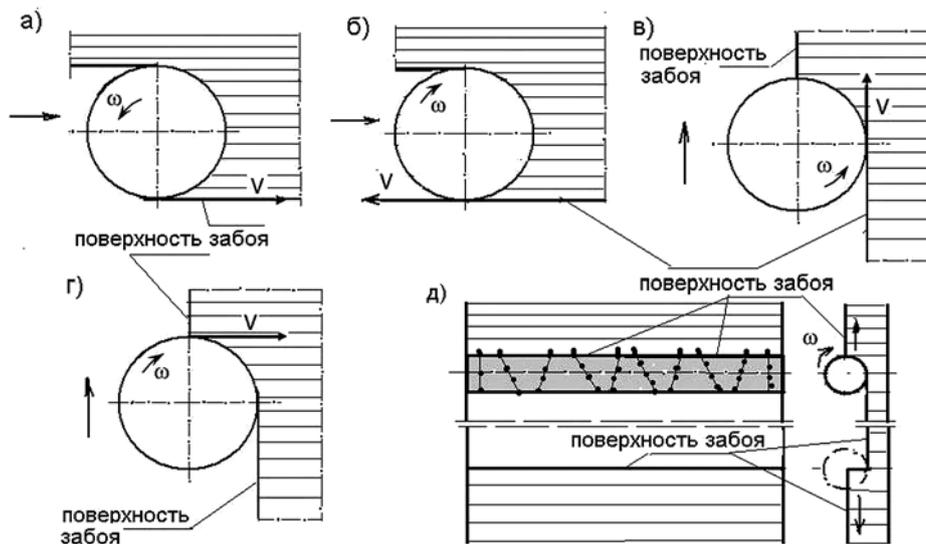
Схемы обработки и режимы фрезерования массива: а, б — обработка забоя горизонтальными слоями; в, г — обработка забоя вертикальными слоями; а, в — попутный режим резания массива резаками; б, г — встречный режим резания массива резаками; д — обработка массива от центра вначале вверх, а затем — от центра вниз
